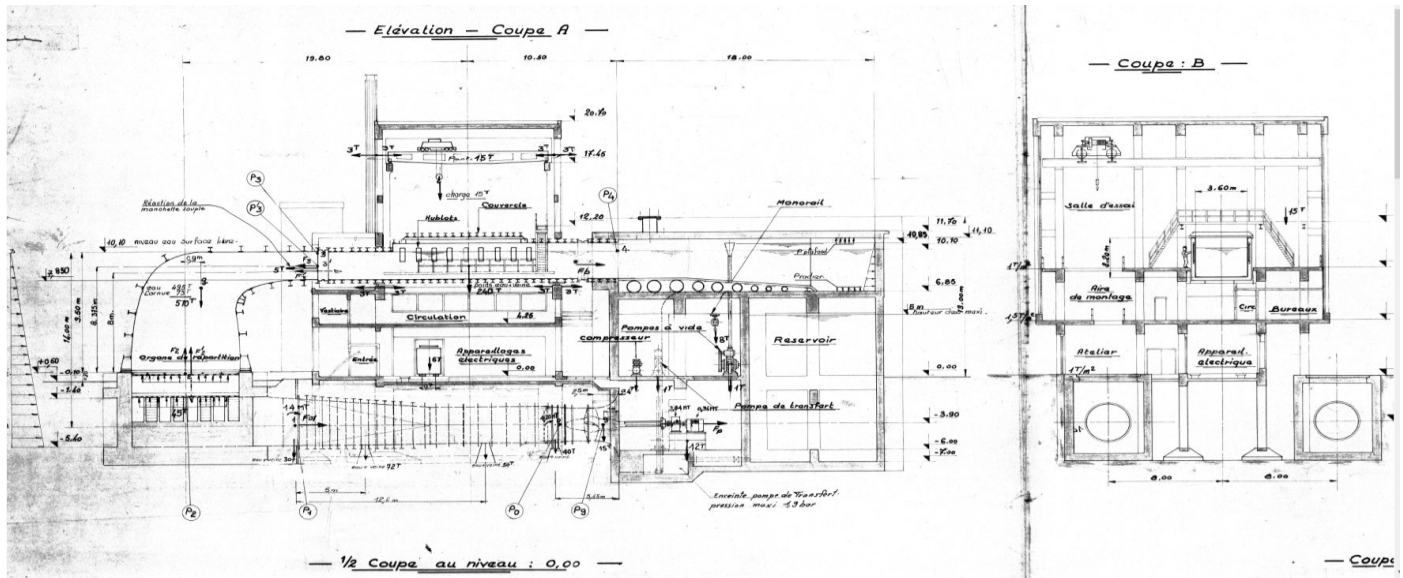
Vista longitudinale del layout del canale di circolazione dell'INM
